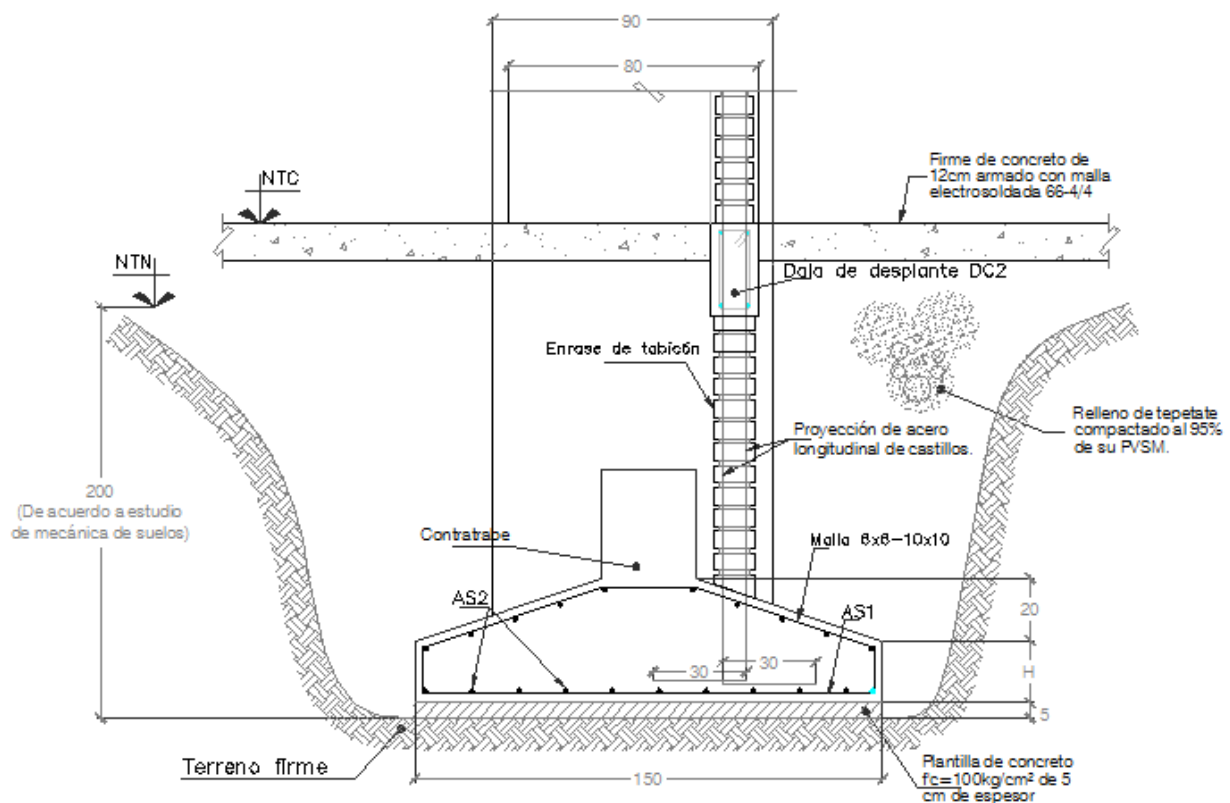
Detalle de la Zapata corrida ZC1 del proyecto actual.
